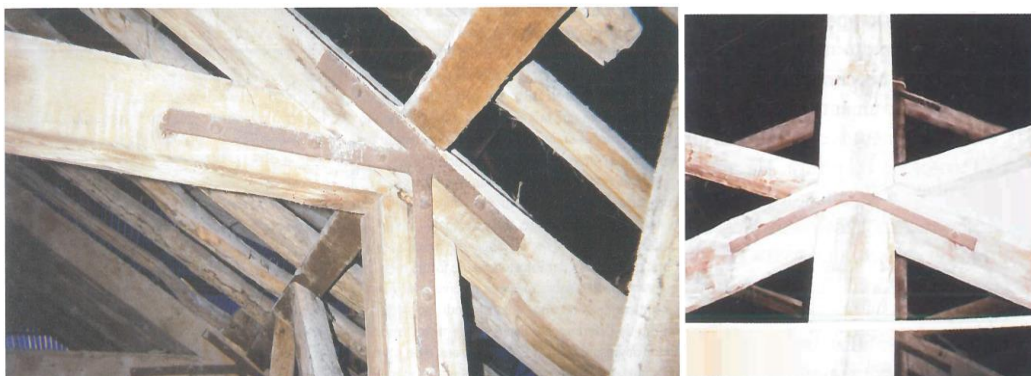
Pormenores e vistas gerais da cobertura com Recurso a ligações metálicas
